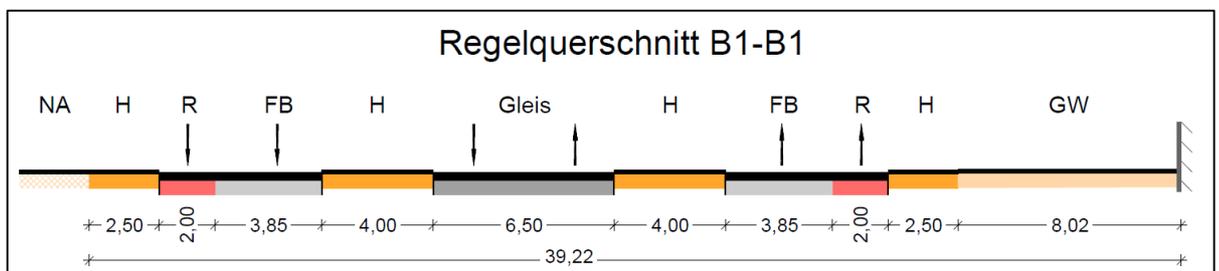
BS geplanter Querschnitt Haltestelle Stadthalle (Angaben in Meter)
